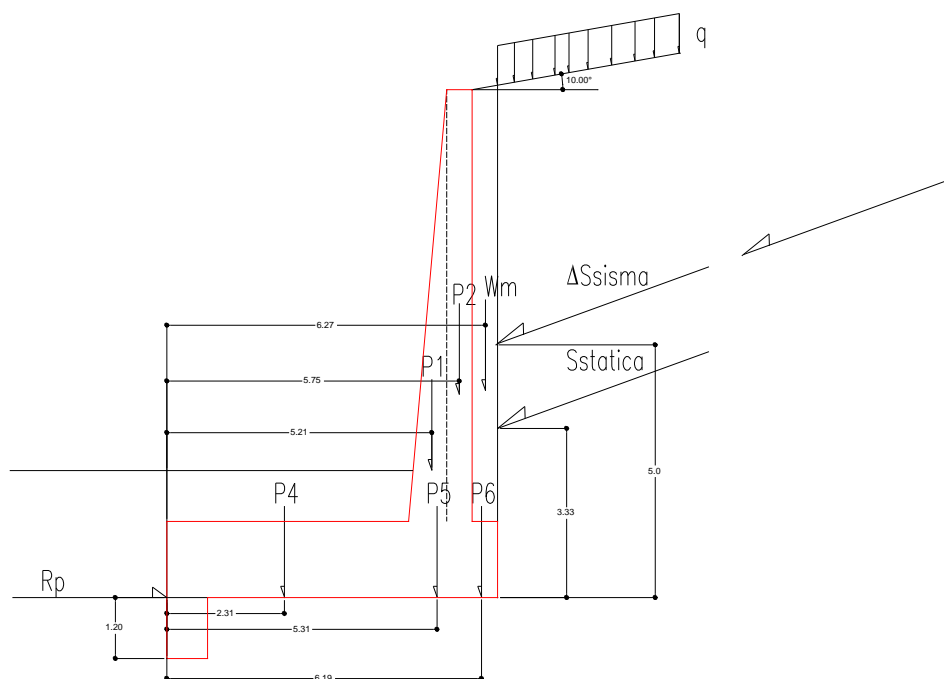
Carpenteria tipo A : Schema delle azioni agenti sul muro
